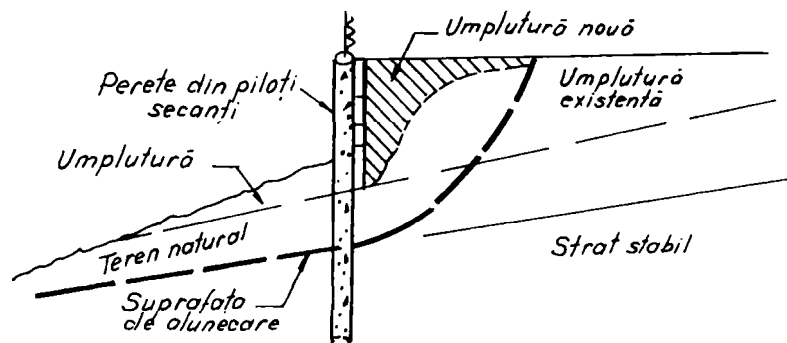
Perete din piloți forajați secanți (perete din piloți cilindrici) pentru stabilizarea unei cedări adânci.
